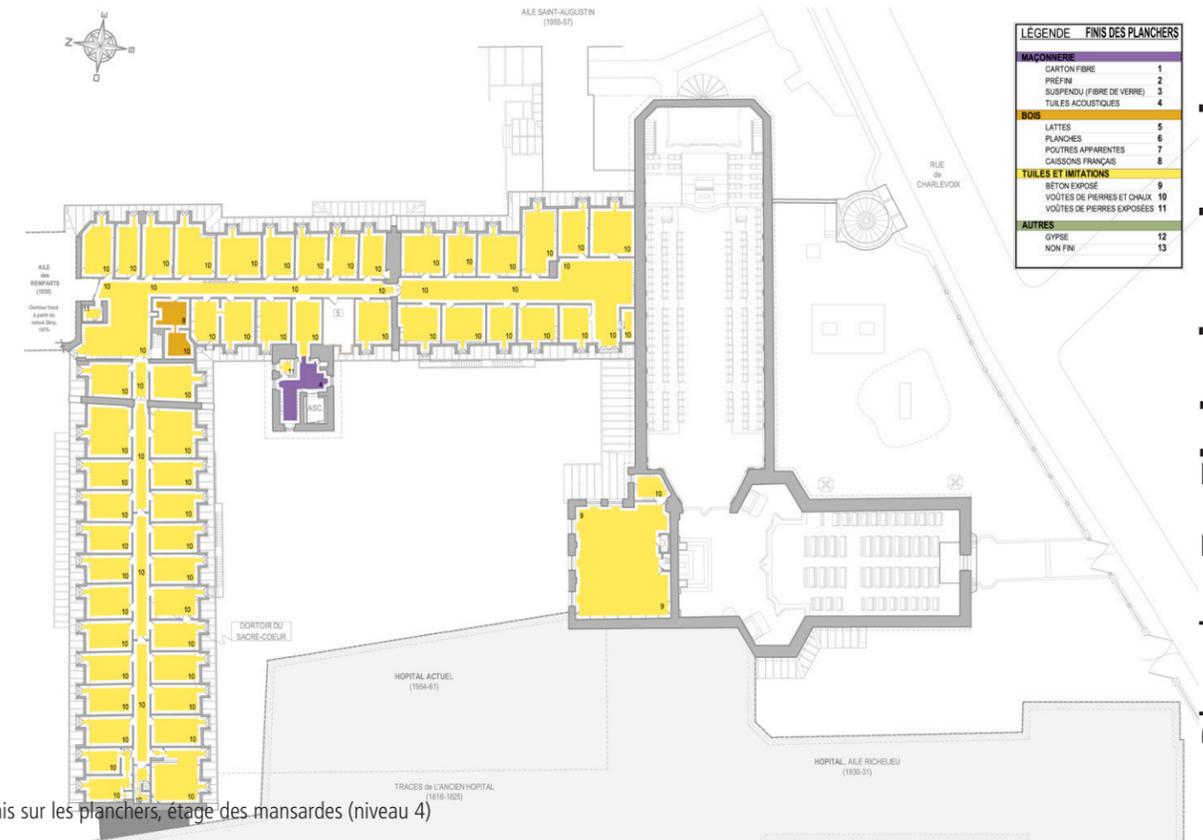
Plan des fins sur les planchers, étage des mansardes (niveau 4)
